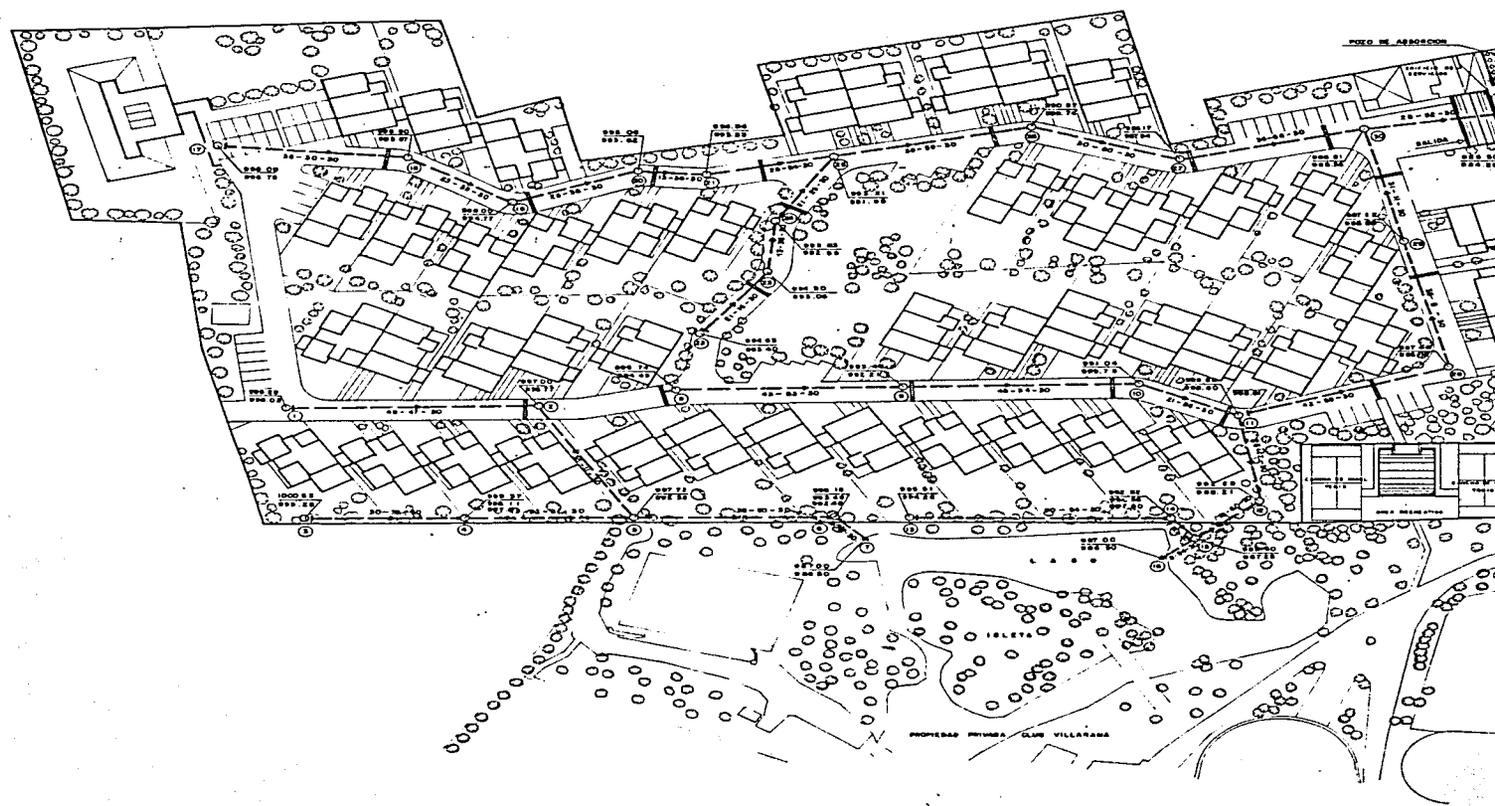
Plano de drenaje pluvial del conjunto habitacional
